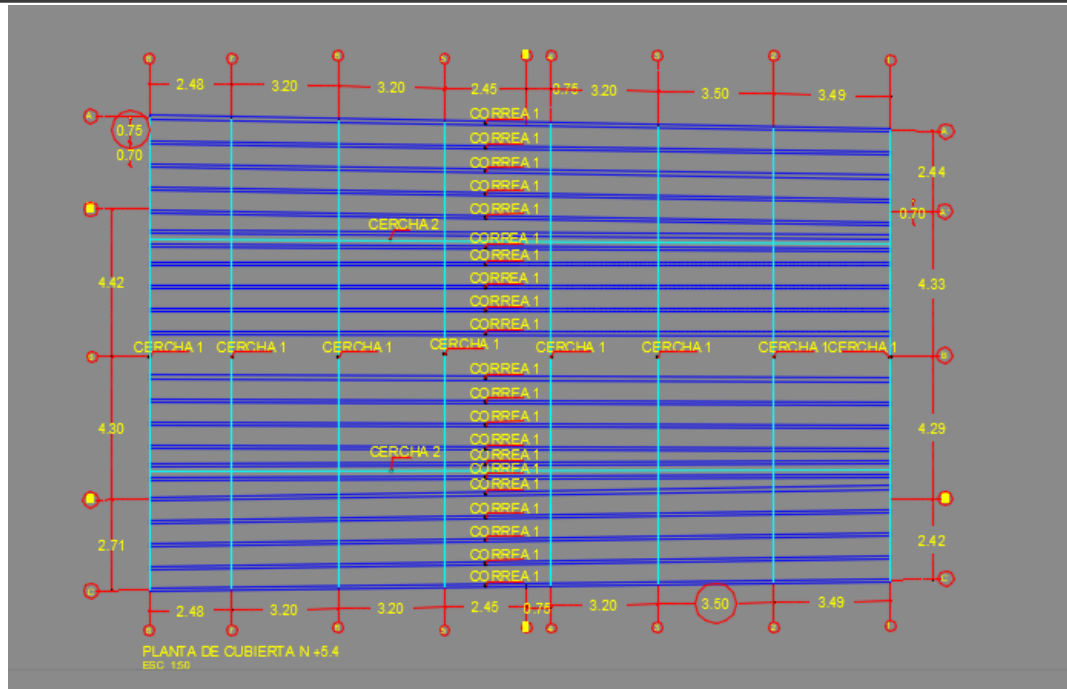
Planta de cubierta con distancias representativas para anchos aferentes
